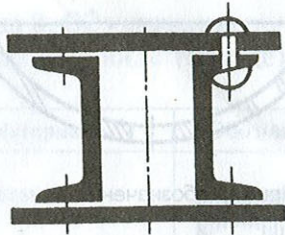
Допускаемое графическое обозначение узких площадей сечений. Сечение ленточного фундамента
